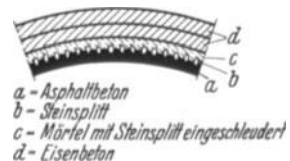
Querschnitt durch ein Schleuderbetonrohr mit einem Billé-Lignonnet-Asphaltfutter. (Bautechn. 1930.)
